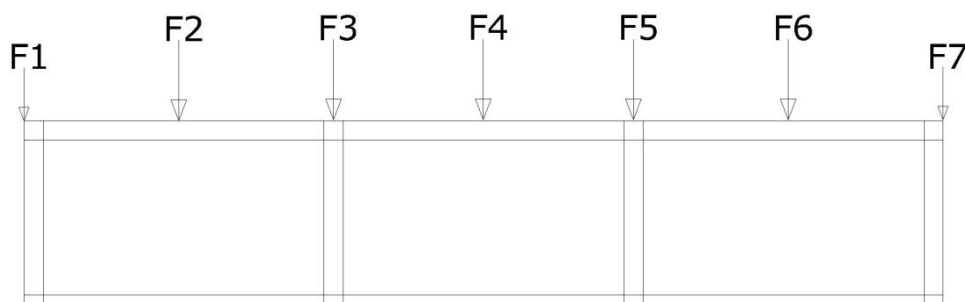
Distribuição das cargas ao nível de uma viga de um pórtico
